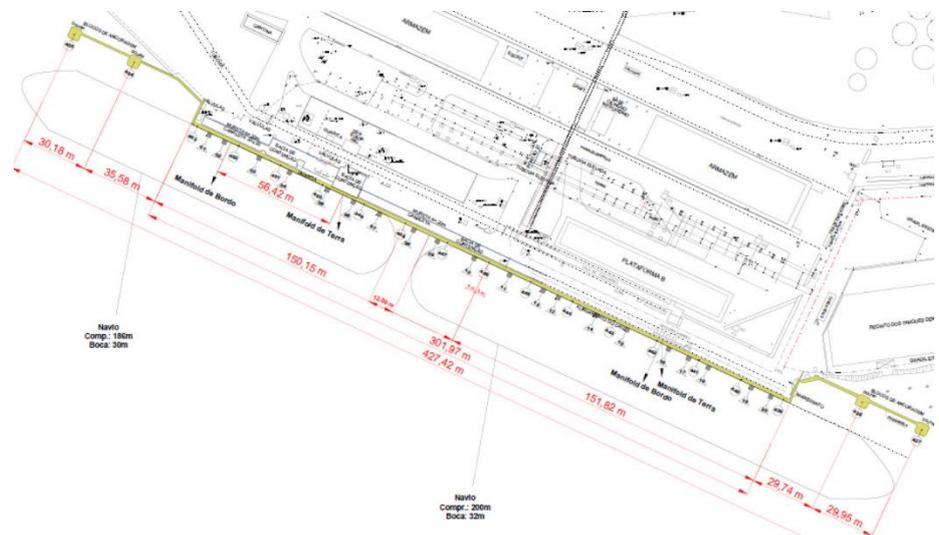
Planta de Localização dos Cais Bocaina e São Paulo
